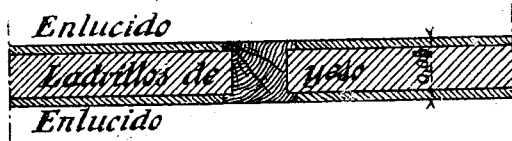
Corte horizontal de un tabique construido con ladrillos de yeso.
